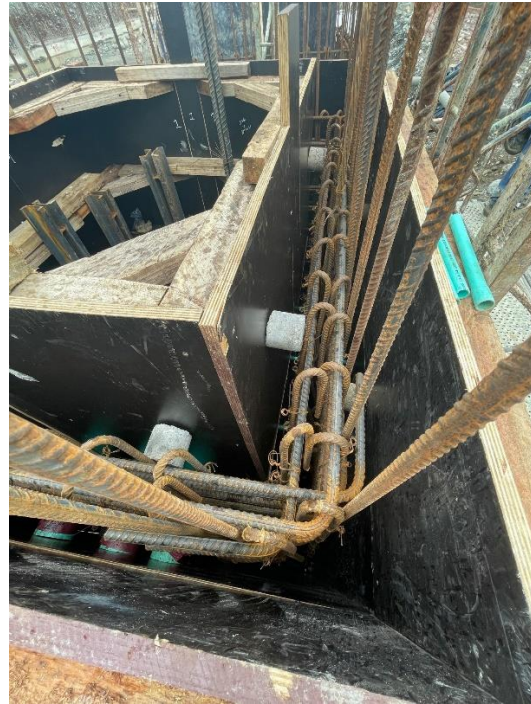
Detalle de canasta de acero y panelas de concreto en encofrado de caja tipo V.
